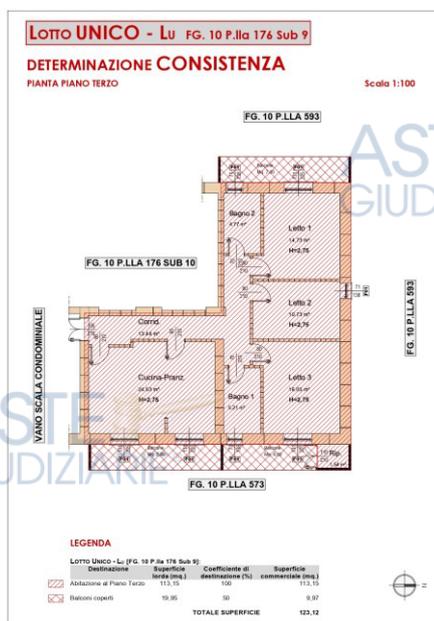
Determinazione consistenza Lotto LU – P. 3. (ALL. 11).
